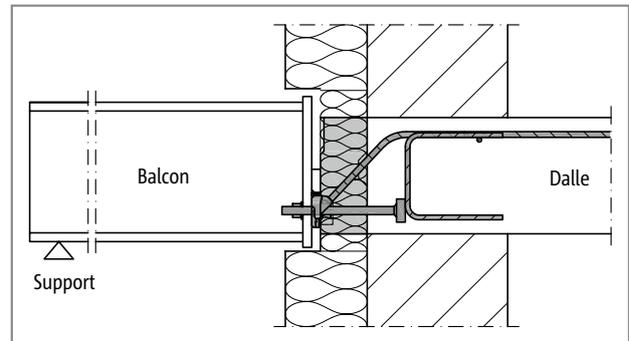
Schöck Isokorb® T type SQ : Raccordement à la dalle en béton ; corps isolant à l'intérieur de l'isolation externe
